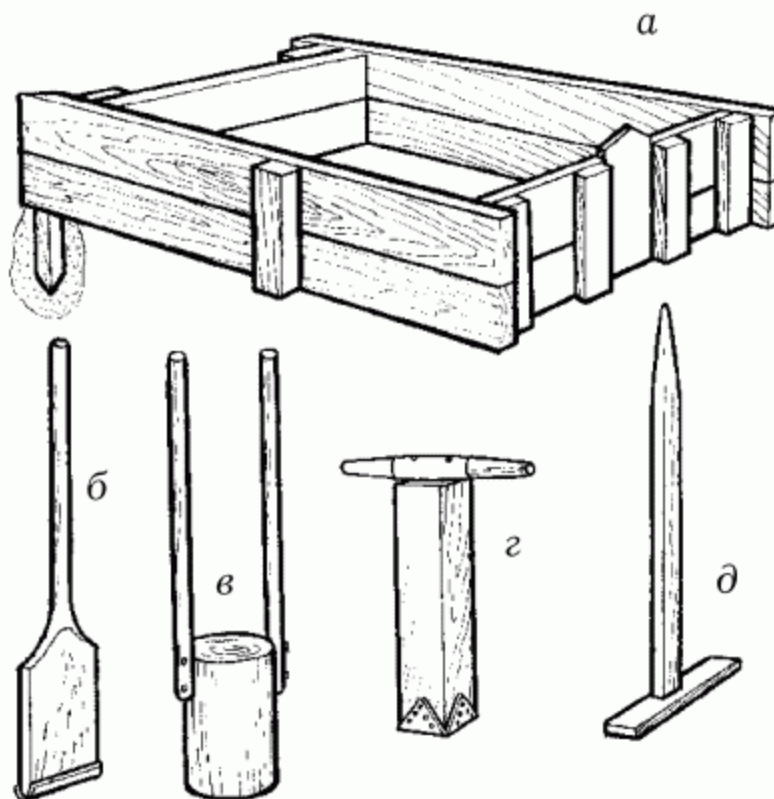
Приспособления для приготовления бетонной смеси: а – деревянный ящик для приготовления бетона; б – узкая трамбовка с металлической обивкой; в – круглая трамбовка с двумя ручками; г – квадратная трамбовка с металлической обивкой; д – гладилка для разравнивания бетона.
